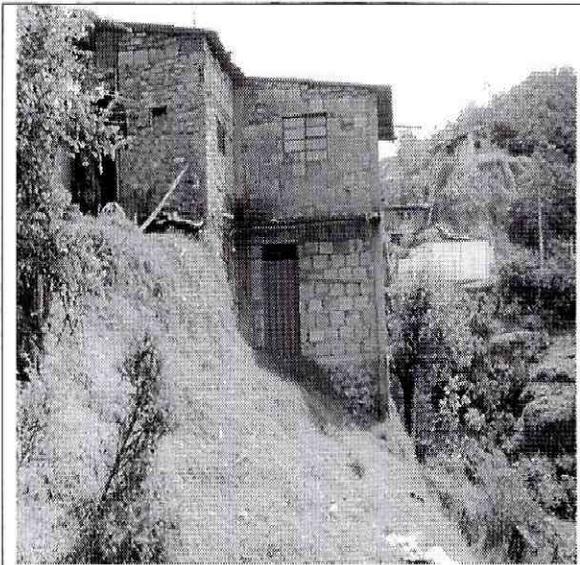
Vivienda de tres pisos en mampostería semiconfinada.
